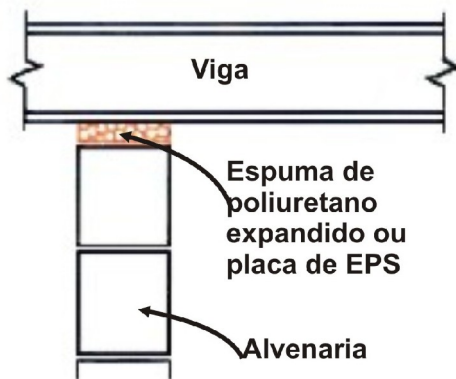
Exemplo de detalhe de ligação desvinculada deformável entre alvenaria e viga metálica.
